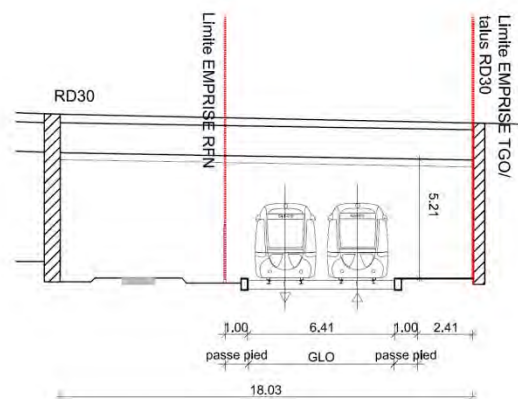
Vue en coupe (AA' sur vue en plan) de l'ouvrage sous la RD 30
